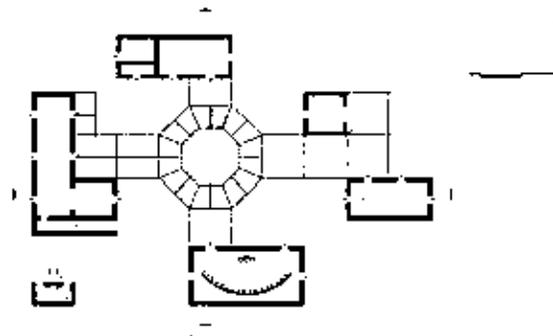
Planta Centro Social Las Margaritas/ Fuente: Archdaily
